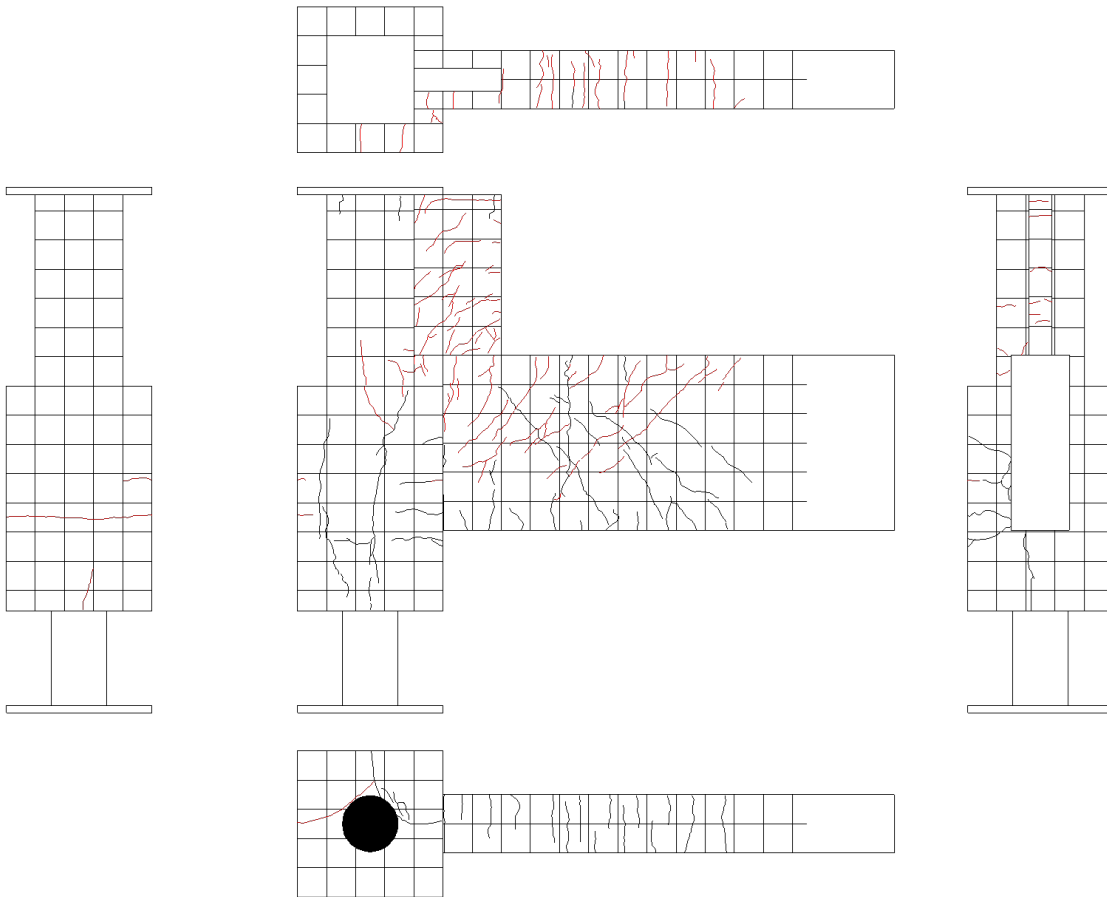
試験体 B-1 ひび割れ状況 (4Cycle)
